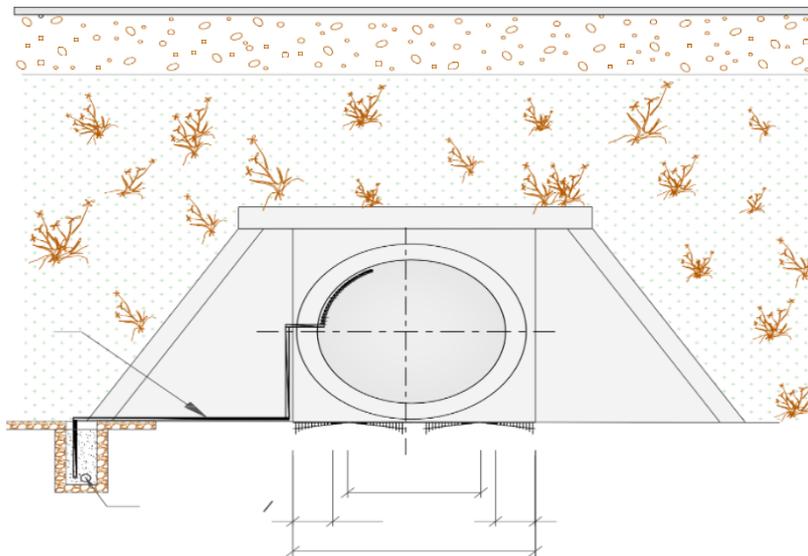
Detalle cruce canalización a través de drenaje transversal bajo calzada y cable de fibra
